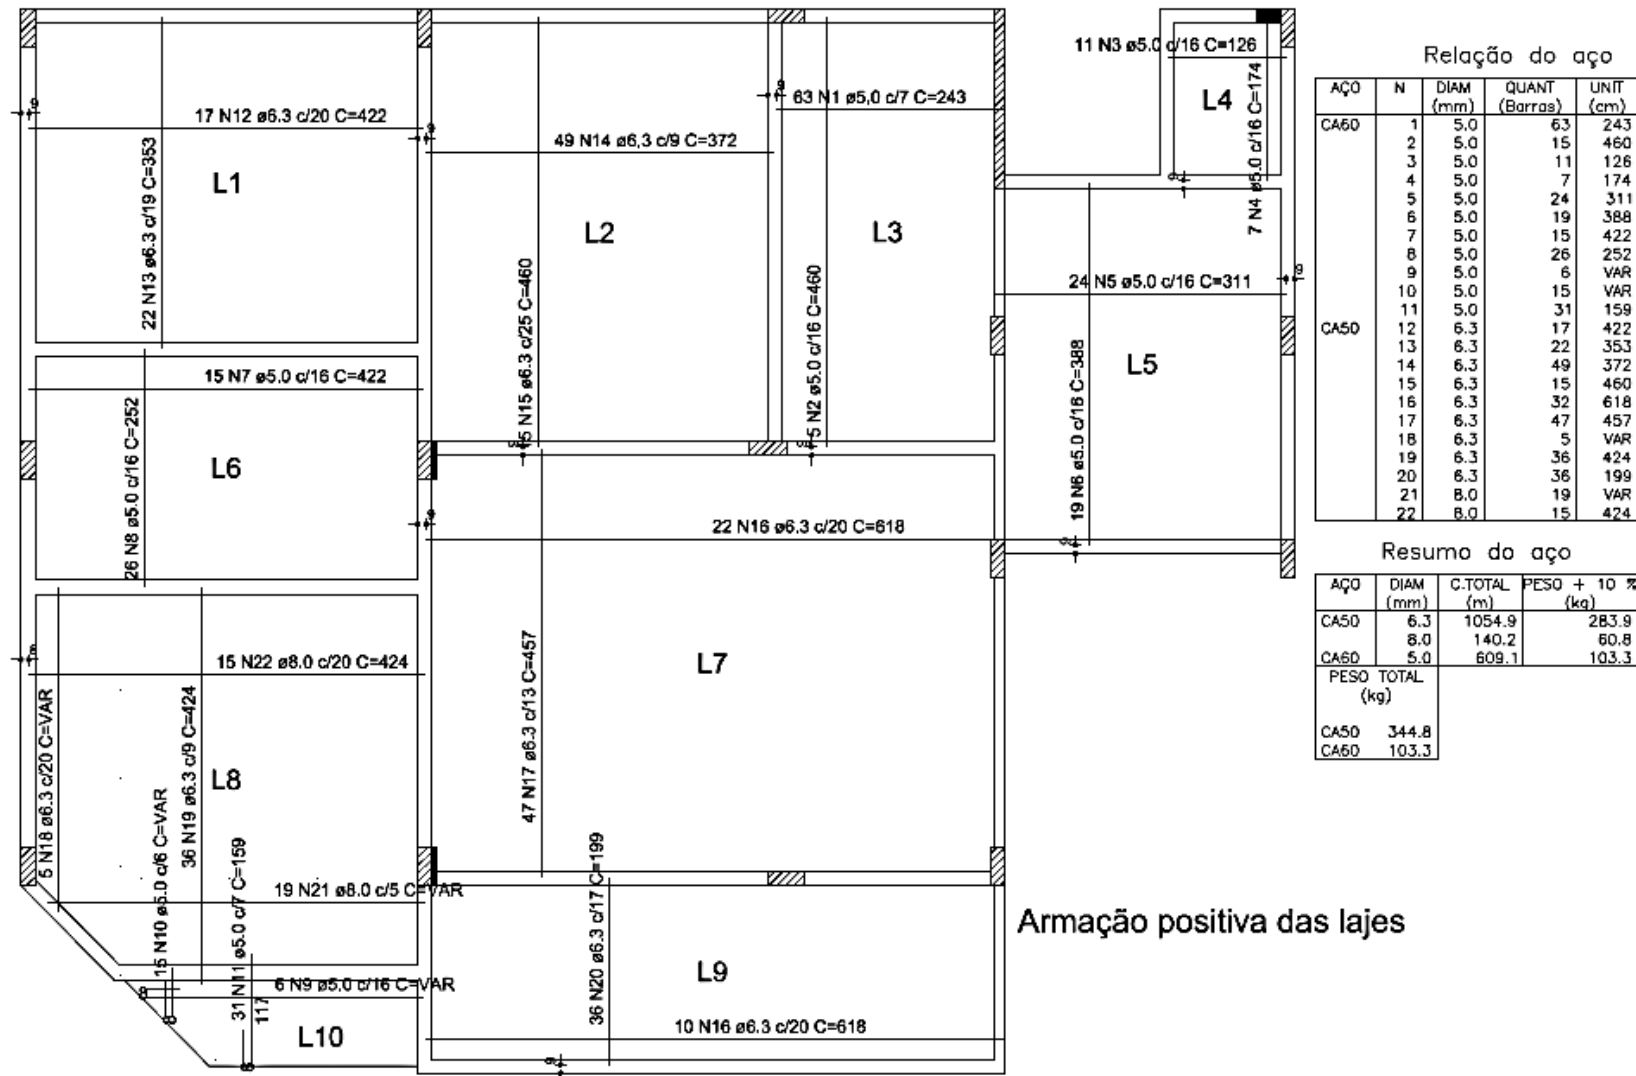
Detalhamento da armadura positiva das lajes com apoios indesejáveis – Eberick
